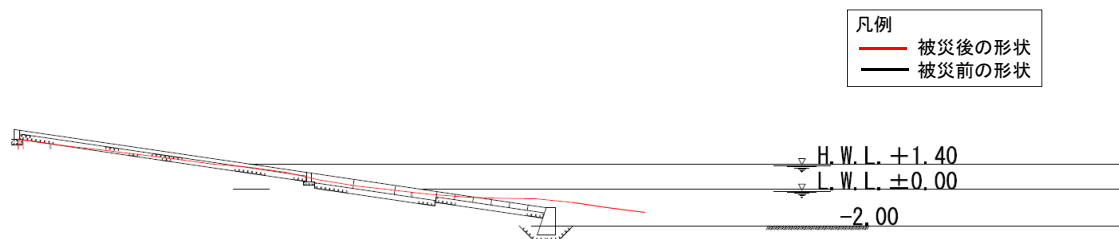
No. 8 北海浜地区第一船溜船着場の斜路断面図 B. P (被災後)
